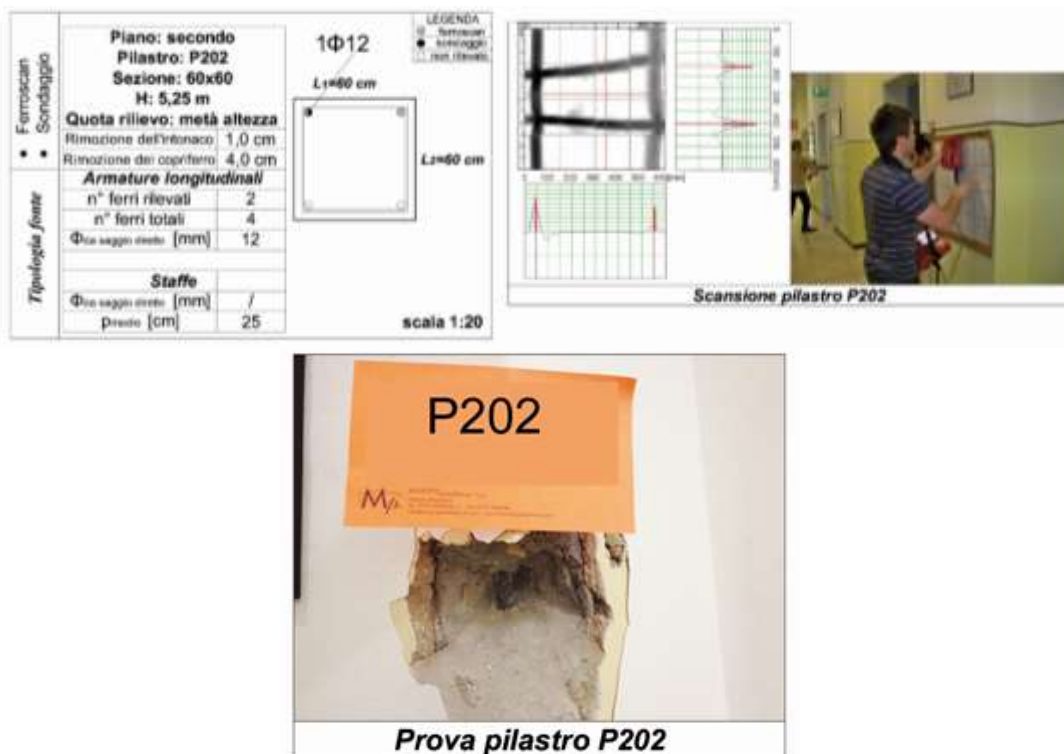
Rilievo pacometrico e saggio diretto su uno dei pilastri interni al piano secondo.
